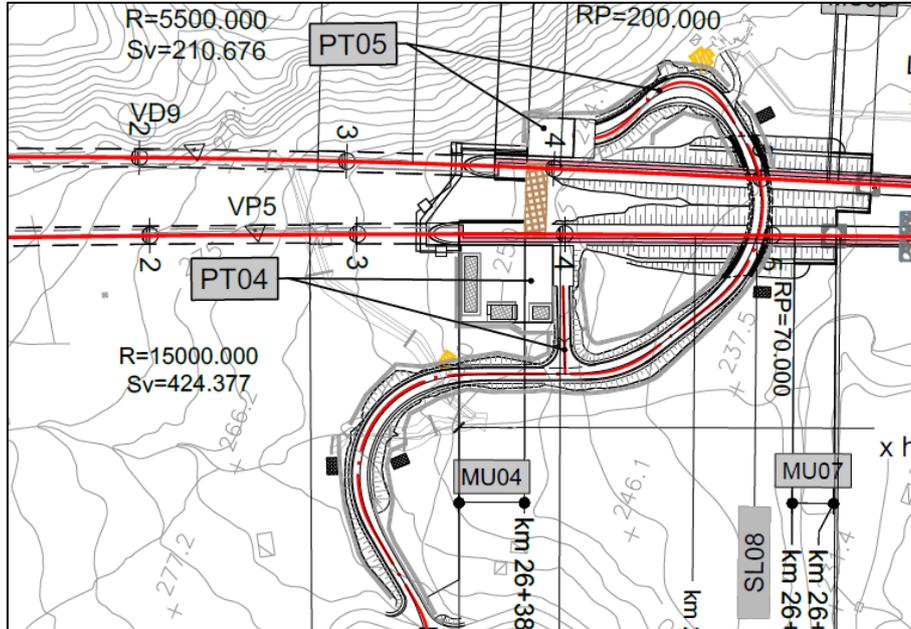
Planimetria con individuazione delle nuove viabilità PT04 e PT05
